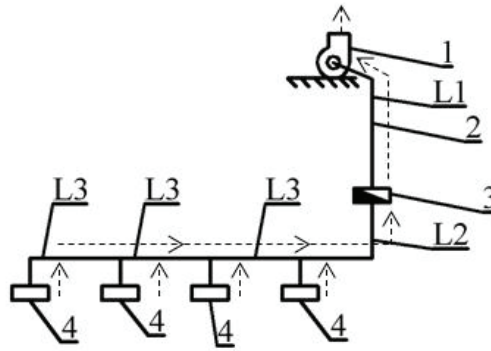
Принципиальная схема вытяжной системы дымоудаления с механическим побуждением: 1 – вентилятор; 2 – воздуховод; 3 – клапан дымоудаления; 4 – дымоприемное отверстие (решетка); L1, L2, L3 – длина участков воздуховода; -> – направление движения дыма.
